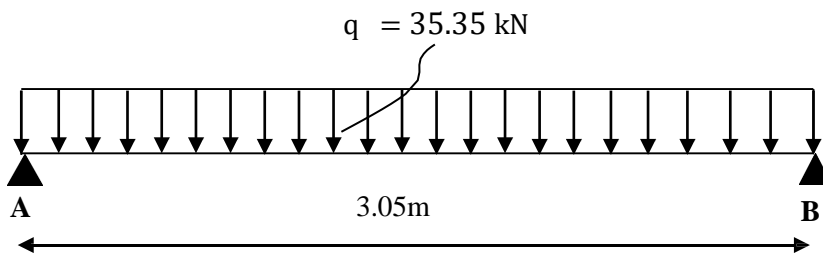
Schéma statique de la poutre palière à l'ELS.
